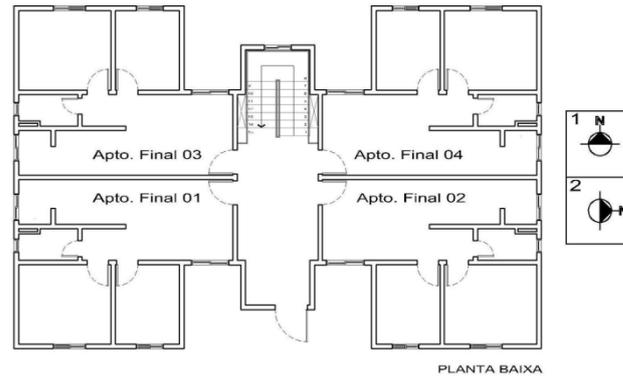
Planta baixa da edificação base de estudo com orientações analisadas.
